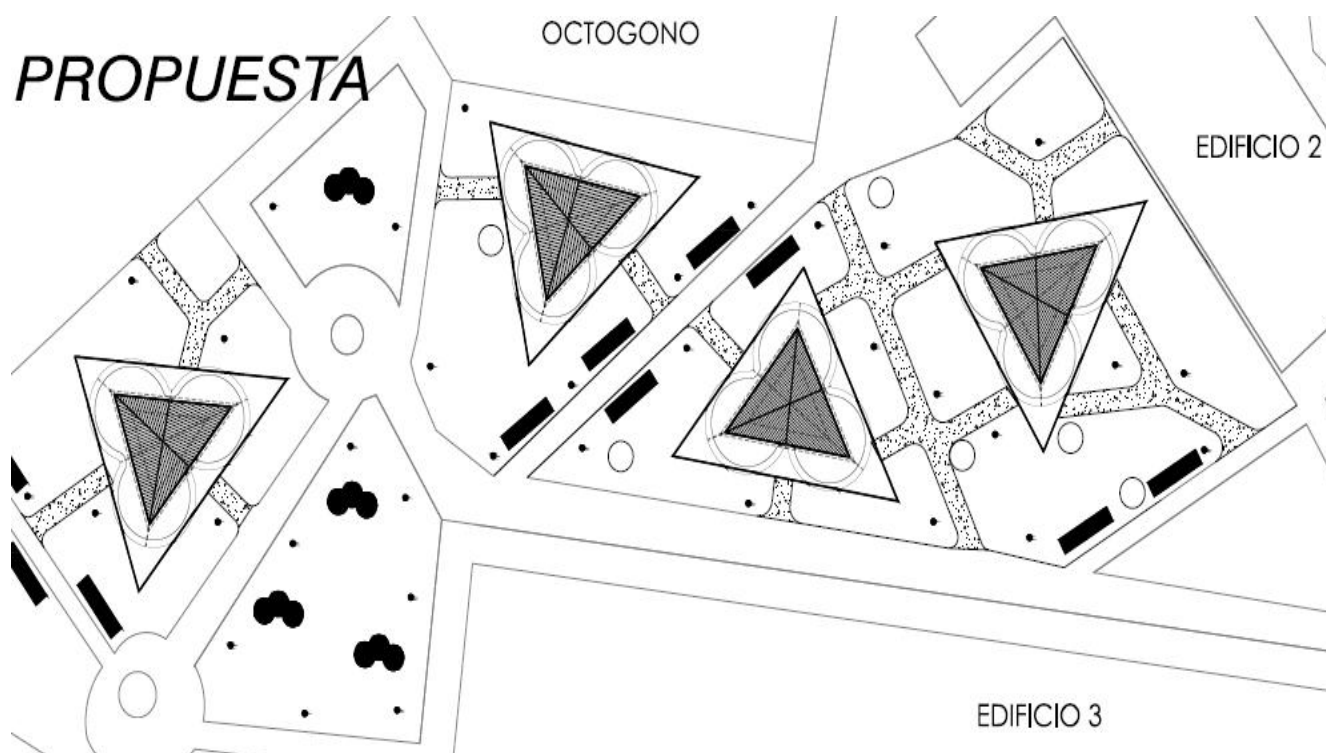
2 Emplazamiento de la propuesta arquitectónica para un grupo de islas de descanso. Departamento de Arquitectura y Arte UTPL [17]
